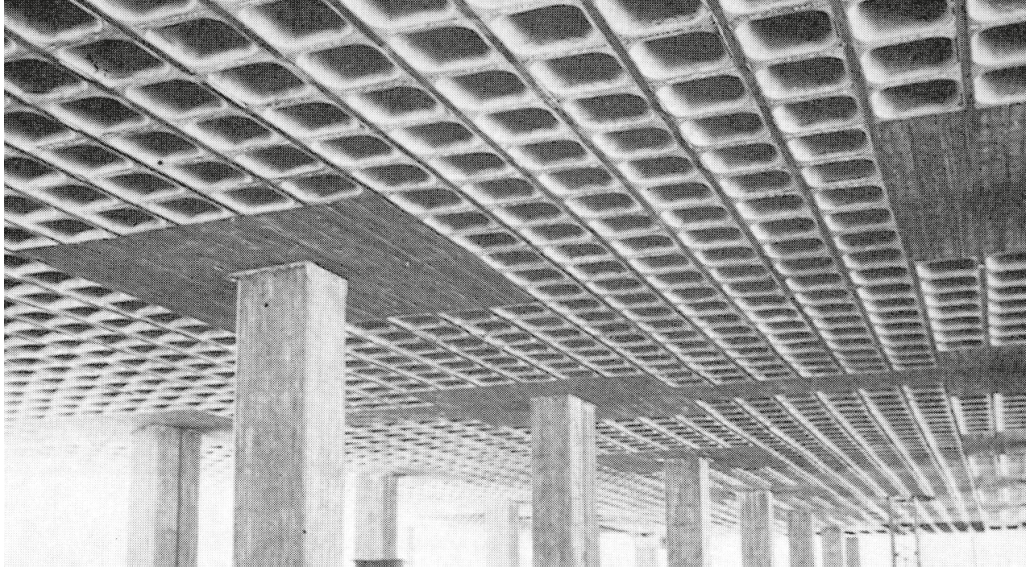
Ejemplo de aplicación de los sistemas estructurales que se pretenden utilizar. Sistema basado en losas nervadas, columnas y cimentación necesaria. Imagen recuperada el 20 de diciembre del 2011 de la <http://html.rincondelvago.com/los-forjados.html>
